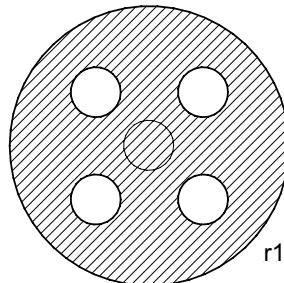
Вид двойного U-образного зонда в разрезе с заполняющей трубой.
